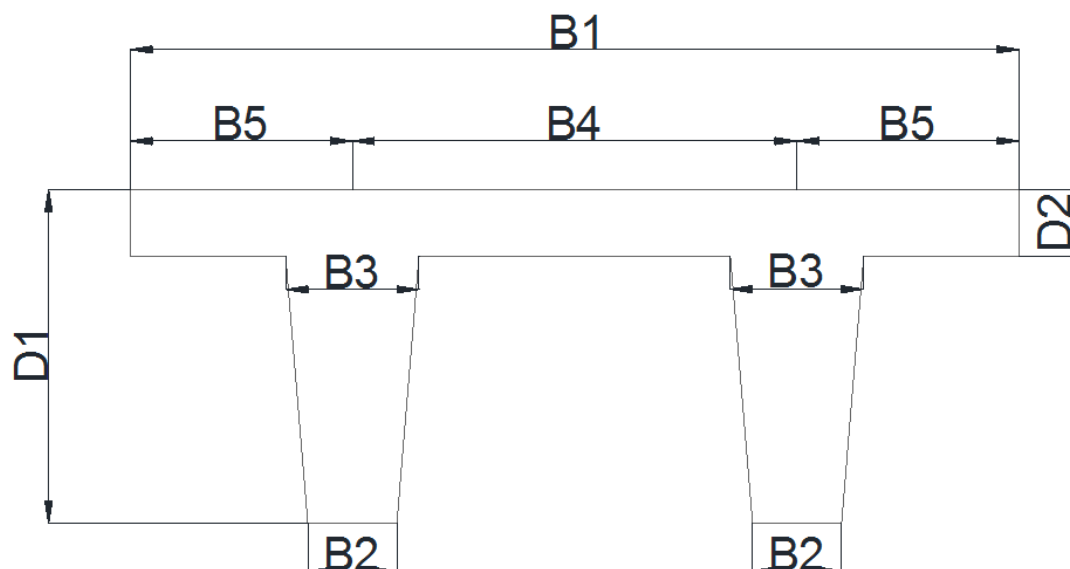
Vigas Doble T (Elaborado por Autores)
